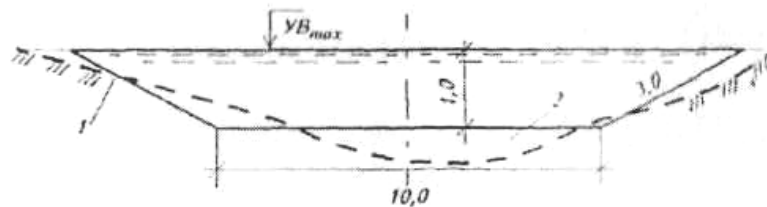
Схема к расчету и подбору крепления откоса (м): 1 – поперечное сечение естественного русла водотока, 2 – схематизированное поперечное сечение русла
